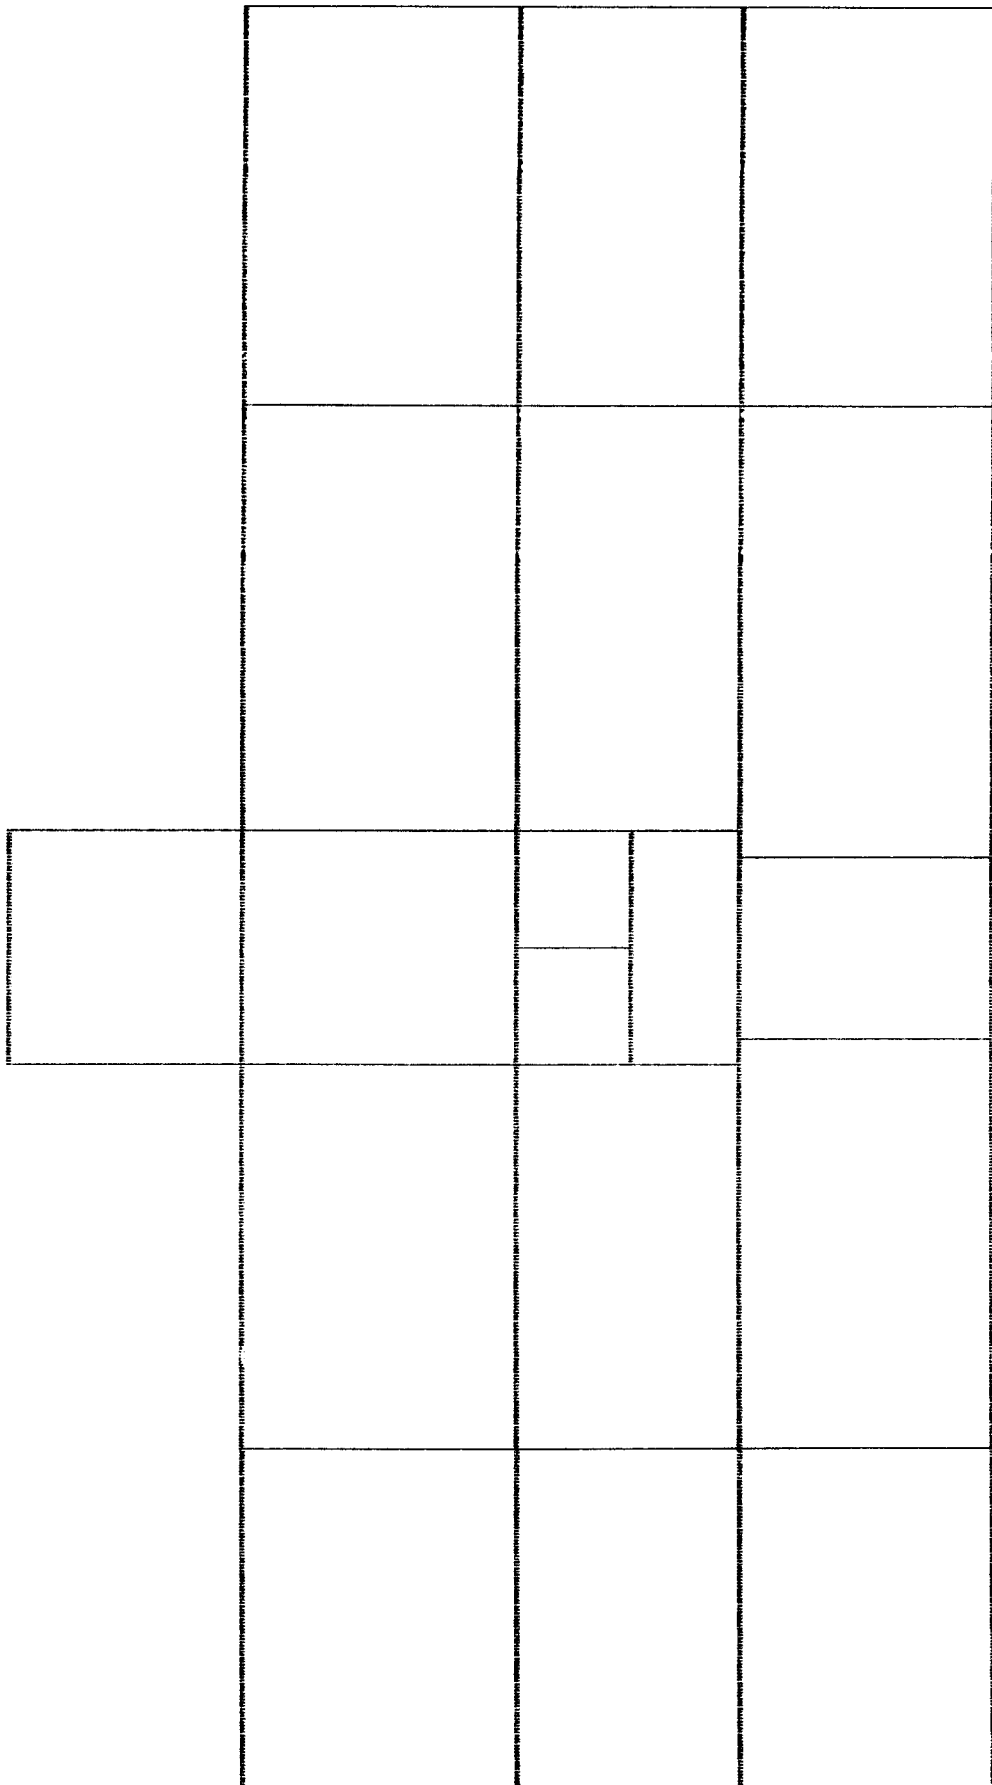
Vista em planta do 1.º pavimento (térreo)
